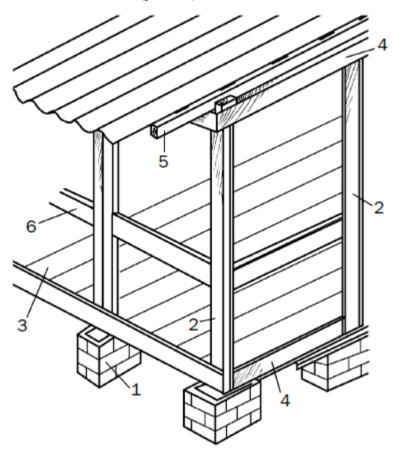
Конструкция террасы: 1 – фундамент; 2 – опоры; 3 – пол; 4 – верхняя и нижняя обвязки; 5 – стропила; 6 – ограждение
